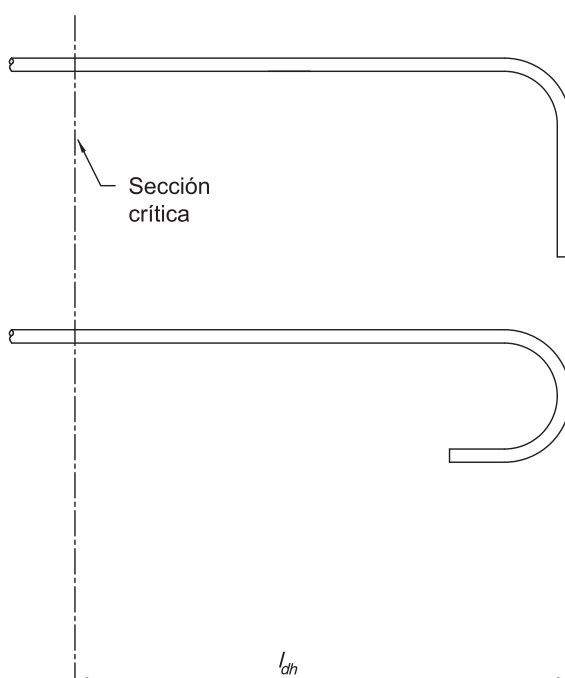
Detalles de barras dobladas para desarrollar el gancho estándar en el refuerzo longitudinal.
